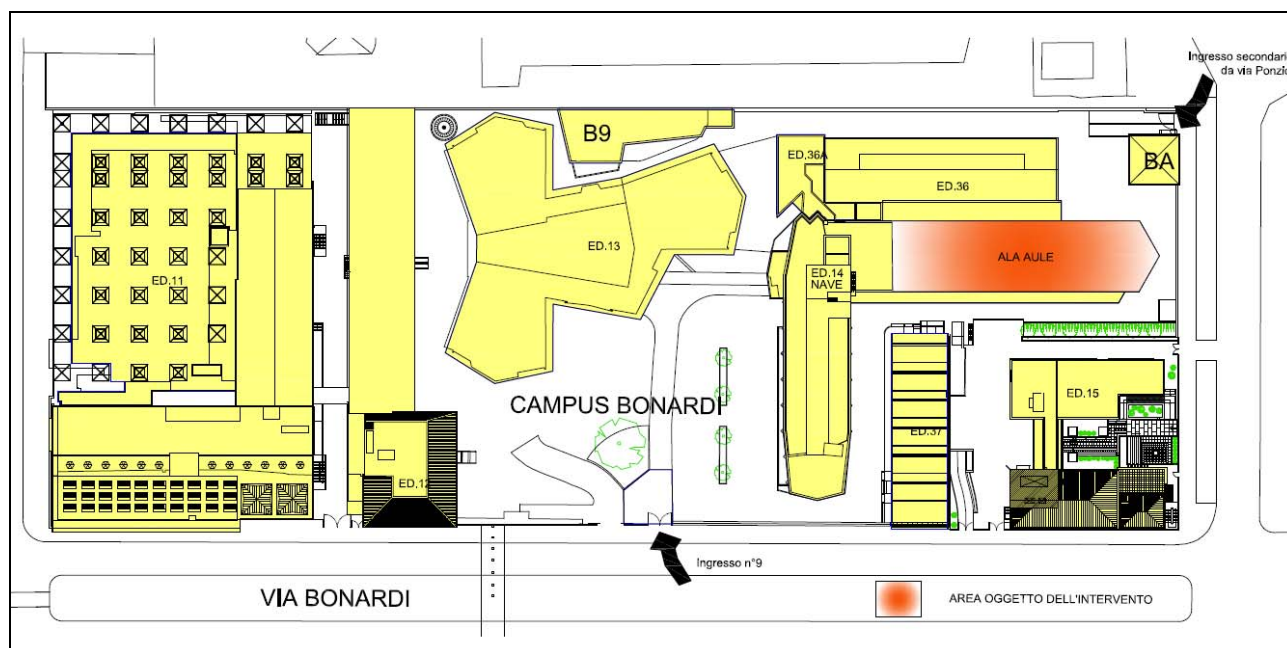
Planimetria Area Bonardi con evidenziazione Edificio 14
